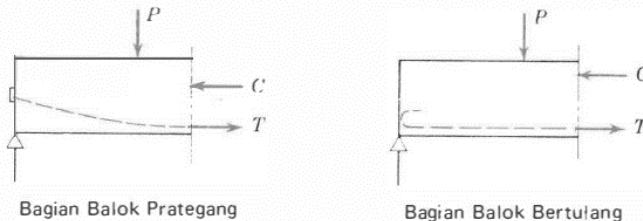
6 Tegangan yang Bekerja pada Beton Prategang
